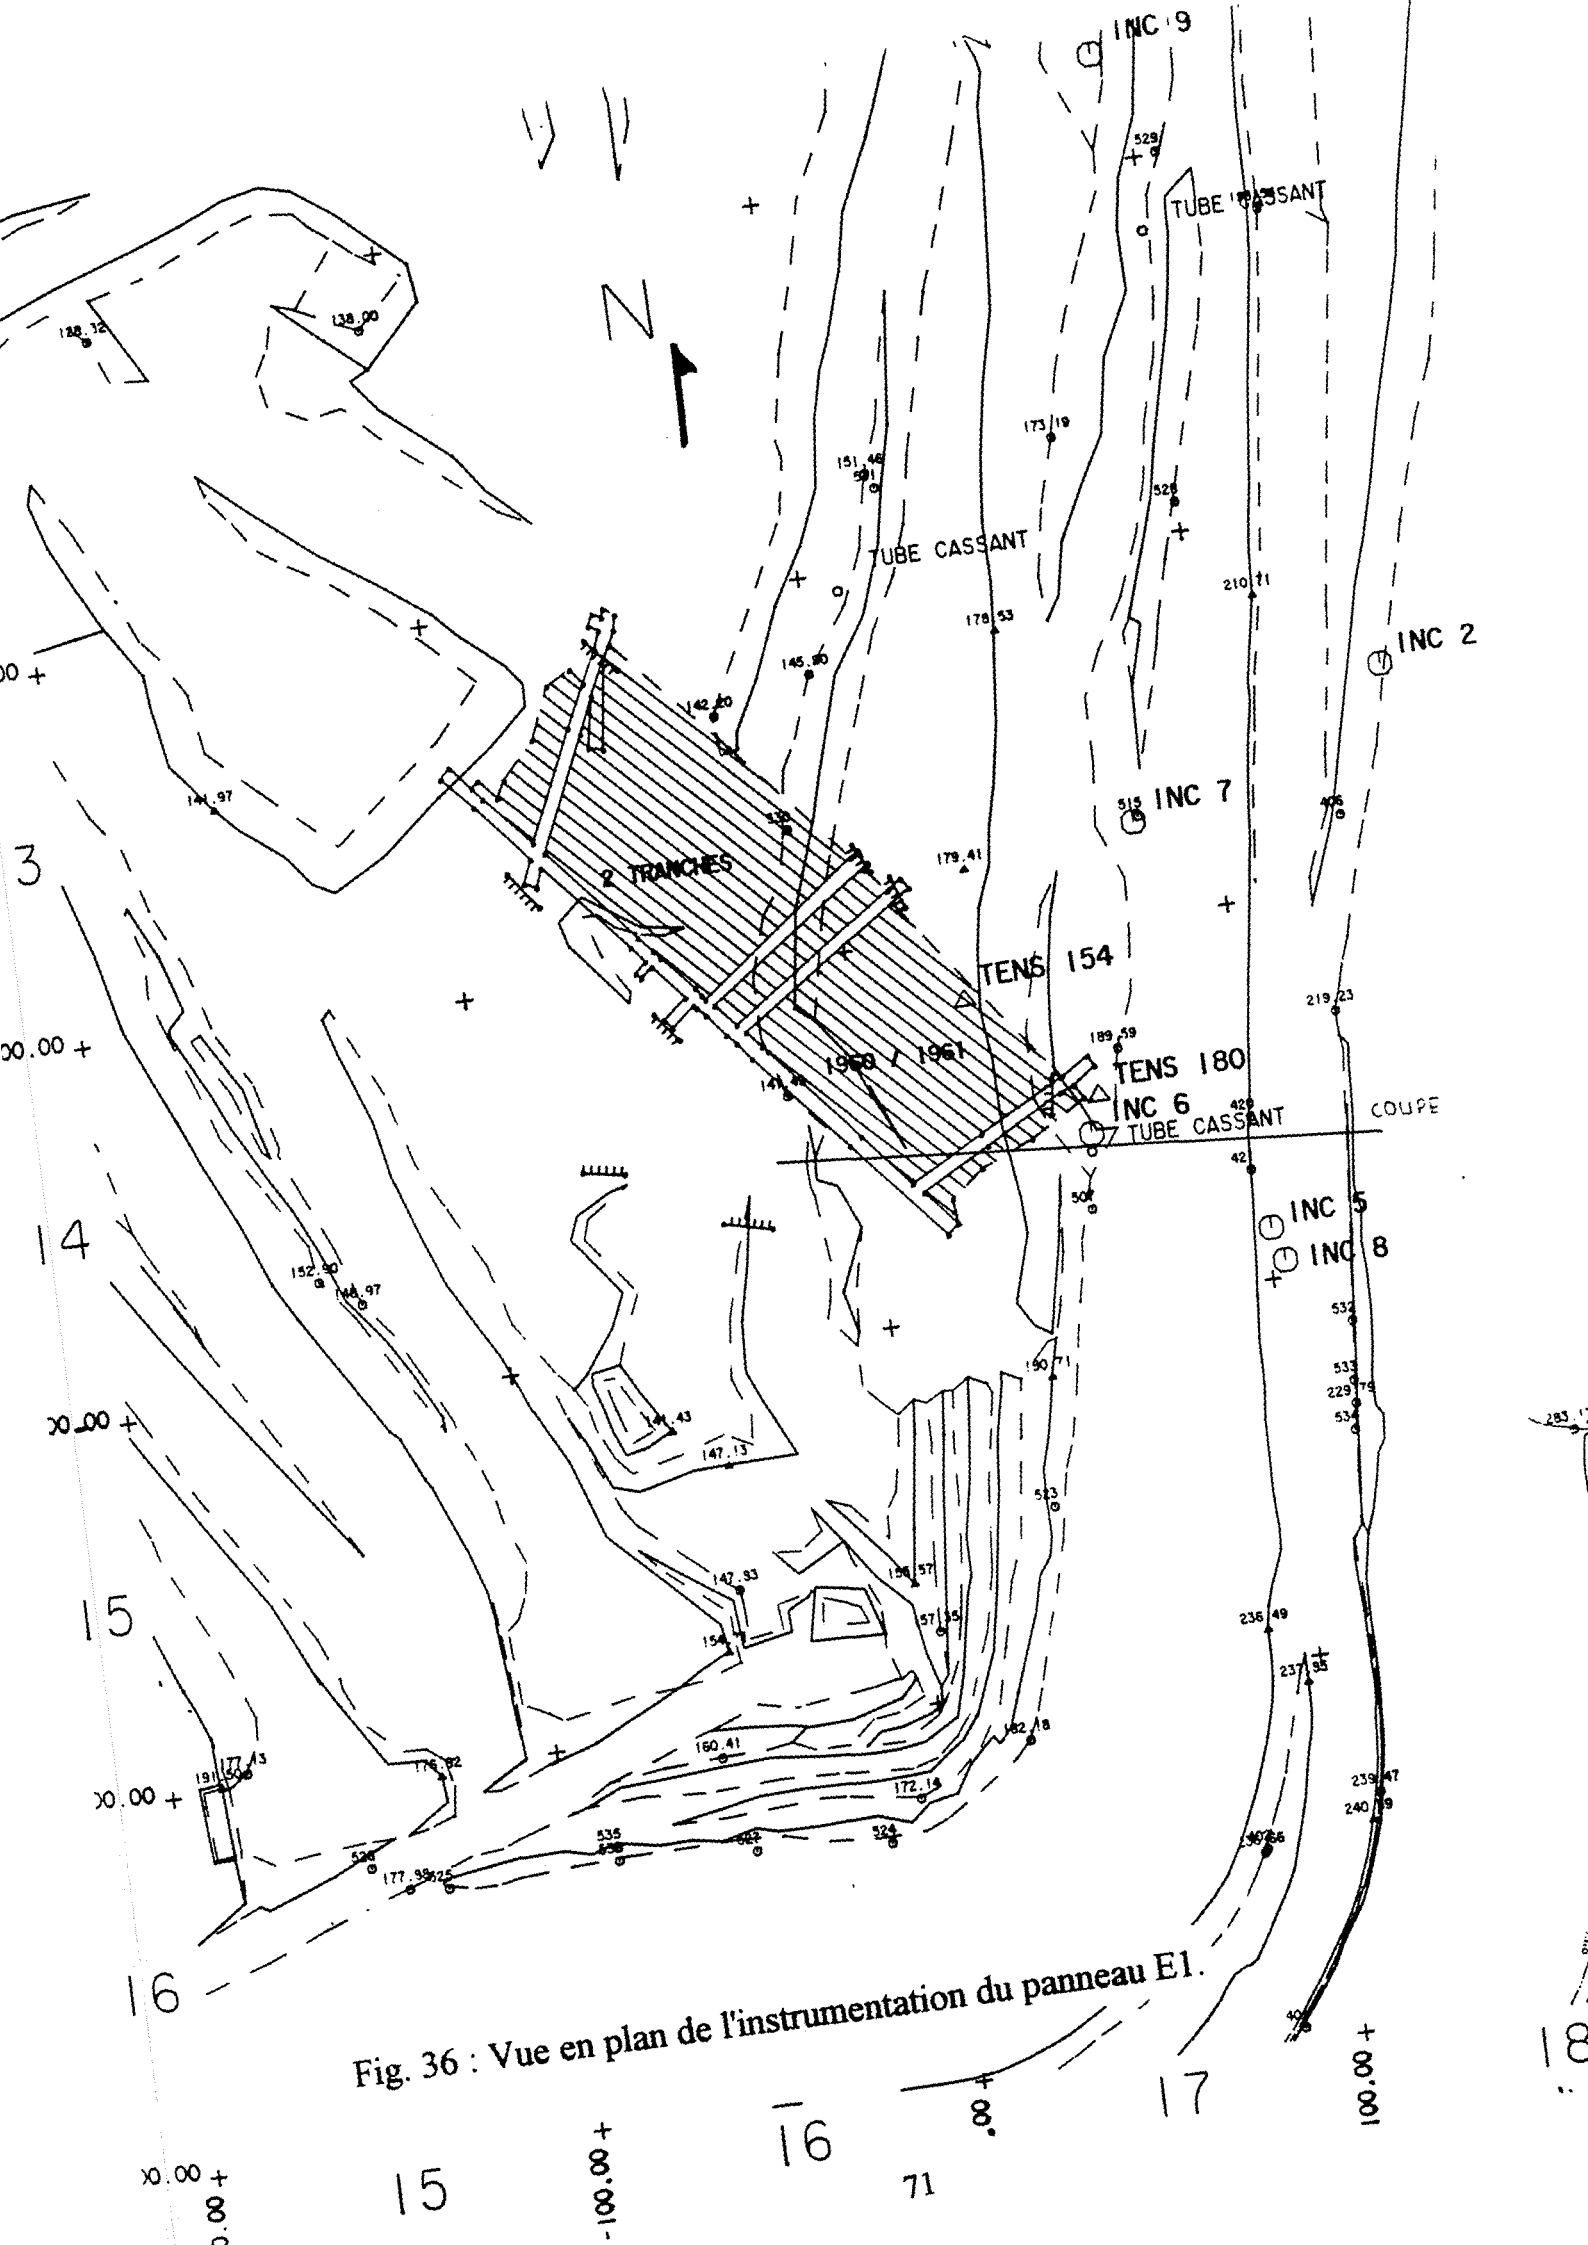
Vue en plan de l'instrumentation du panneau E1.
